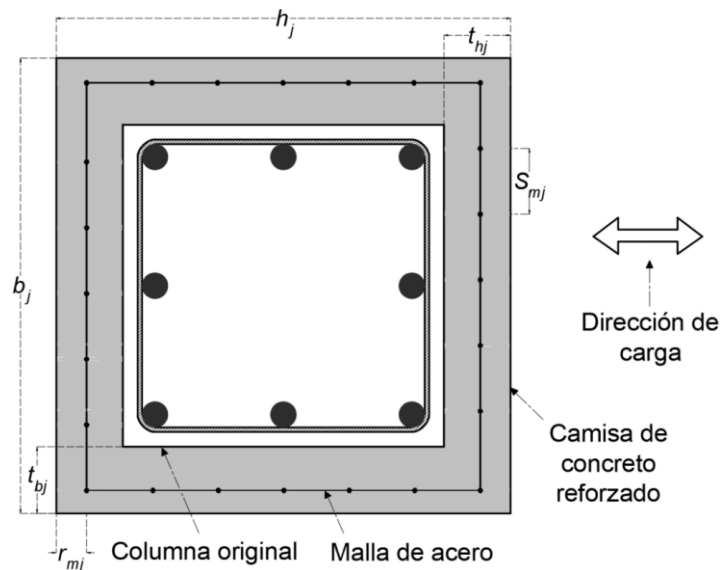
Configuración de la sección transversal de la columna encamisada con concreto reforzado con malla de acero
